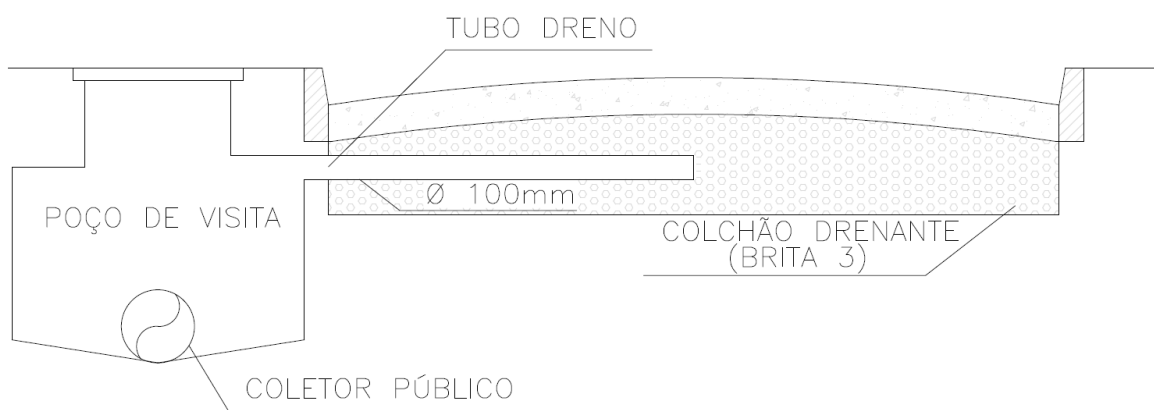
Perfil típico do pavimento permeável com concreto poroso
